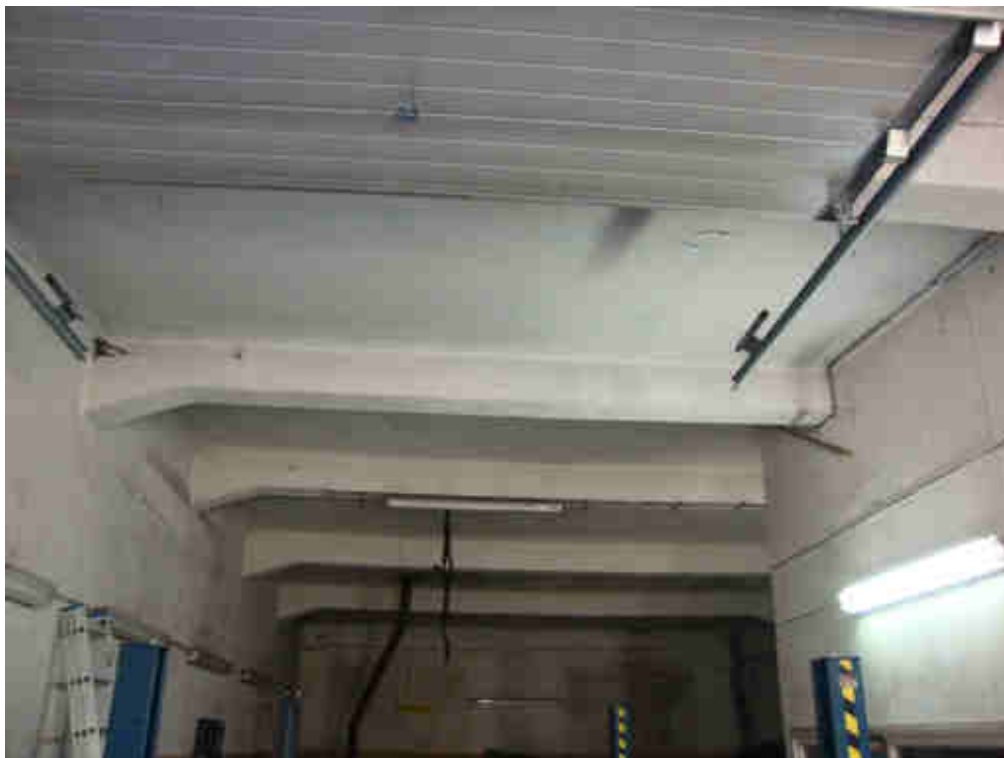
Hoone sisevaade. Hoonel tellisseinad, betoontaladega laed
